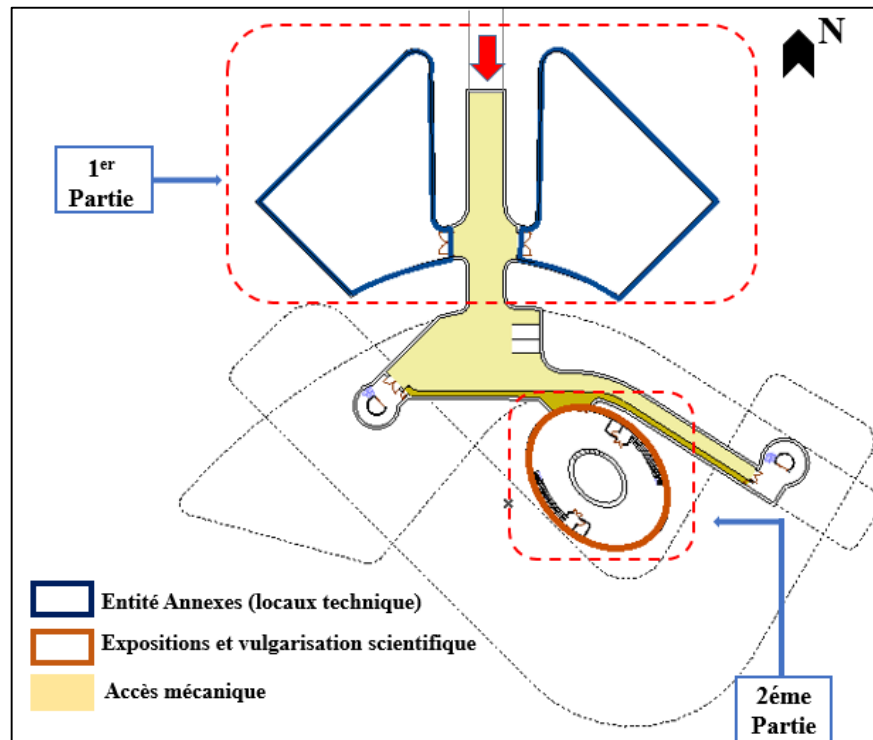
Plan Sous-Sol -06.00 Source : Auteur
